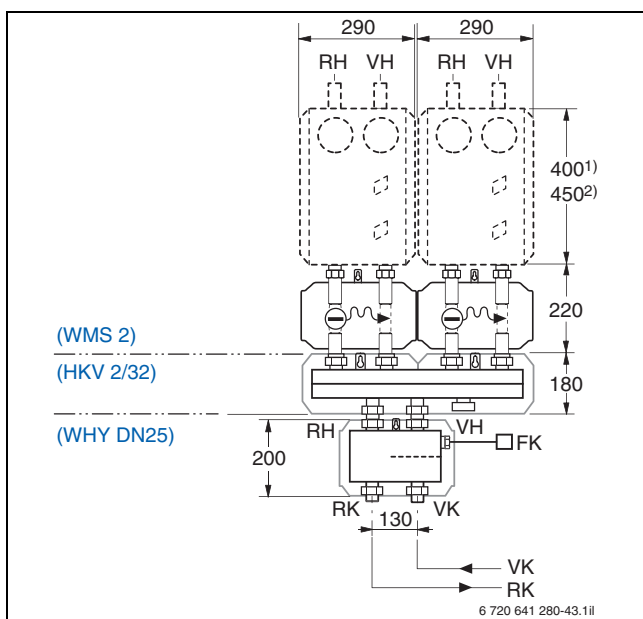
Abmessungen Wärmemengenzähler-Set mit Heizkreisverteiler (Maße in mm)
